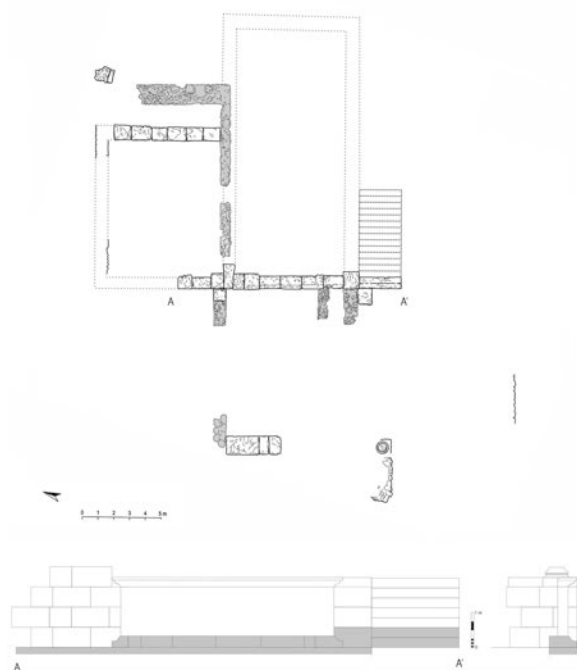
Planta y alzado de las estructuras halladas en el sector A de Alvarfáñez (en gris) y propuesta interpretativa de los volúmenes. (Plano: R. Cebrián).
